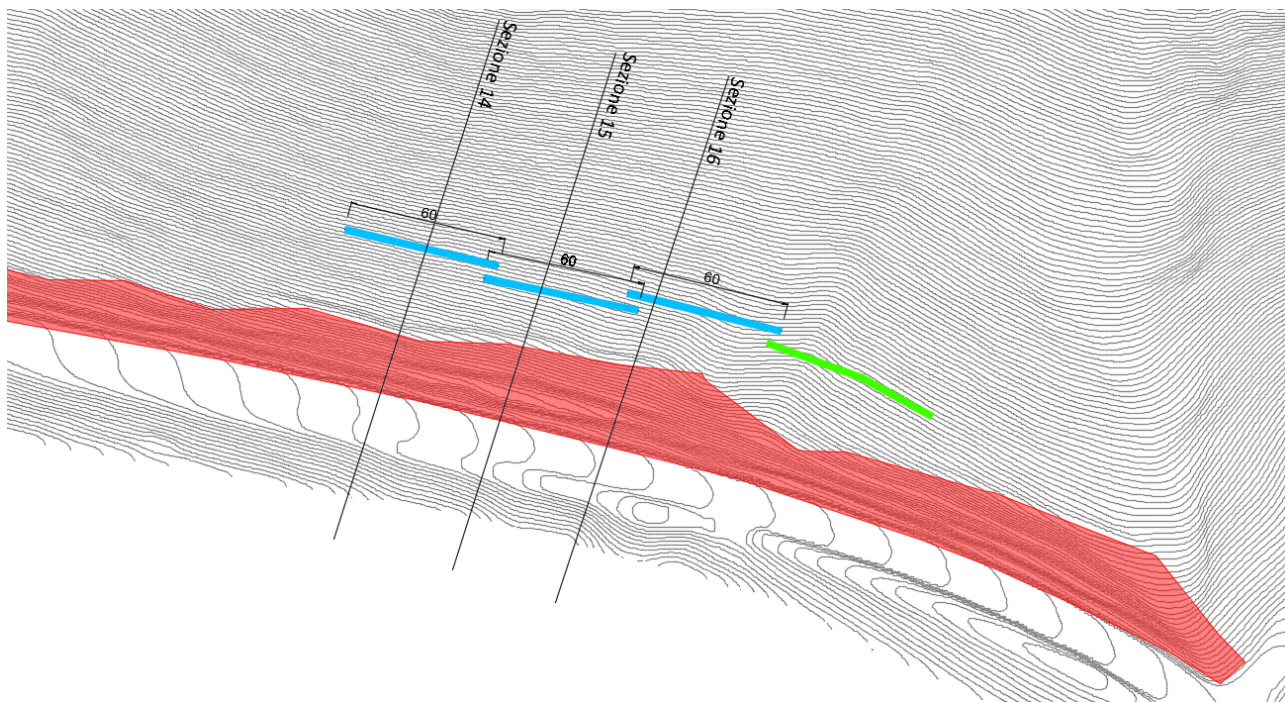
Settore 3 - posizionamento planimetrico barriere
